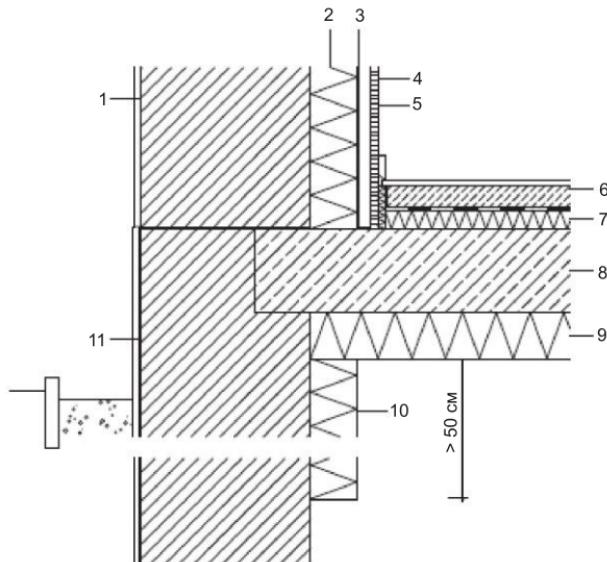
Теплоизоляция подвального перекрытия и ликвидация "теплового мостика" в месте стыка с наружной стеной: 1 — наружная стена (каменная или кирпичная кладка); 2 — внутренняя теплоизоляция наружной стены на первом этаже; 3 — пароизоляционная прокладка; 4 — инсталляционный промежуток; 5 — внутренняя обшивка со стороны помещения; 6 — стяжка и напольное покрытие; 7 — изолирующий слой для защиты от ударного шума; 8 — бетонное перекрытие; 9 — теплоизолирующие плиты под перекрытием; 10 — дополнительная теплоизоляция наружной стены подвального помещения (опускается ниже уровня земли); 11 — герметизация и штукатурка цоколя
